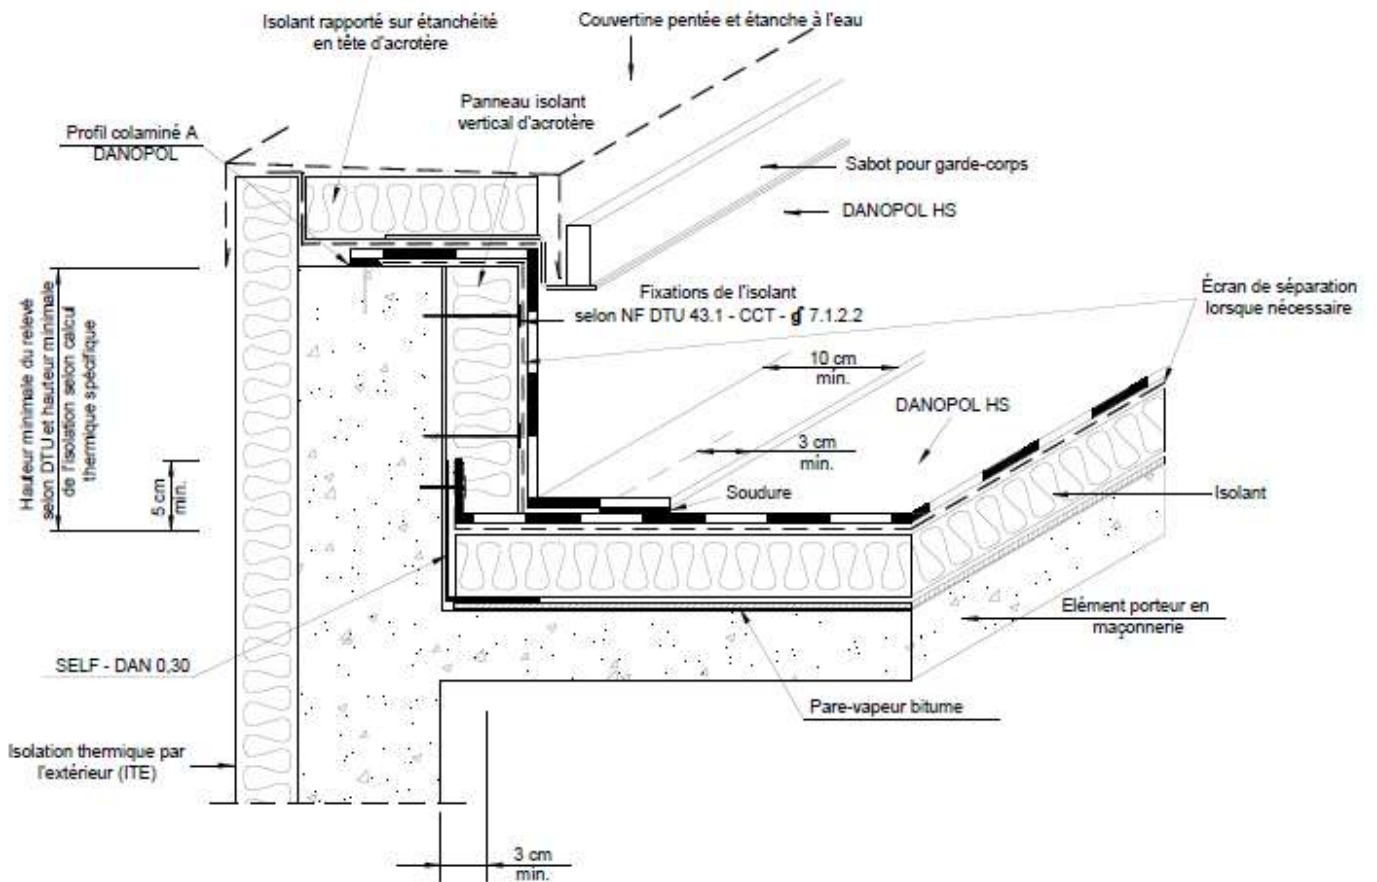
Relevé d'étanchéité sur acrotère béton isolé (pare-vapeur bitume)
